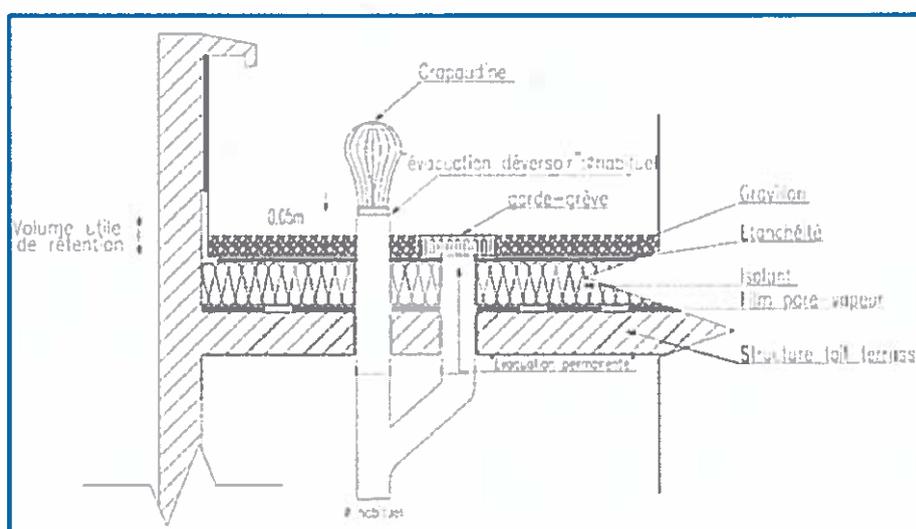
Schéma de principe des constituants d'une toiture stockante
